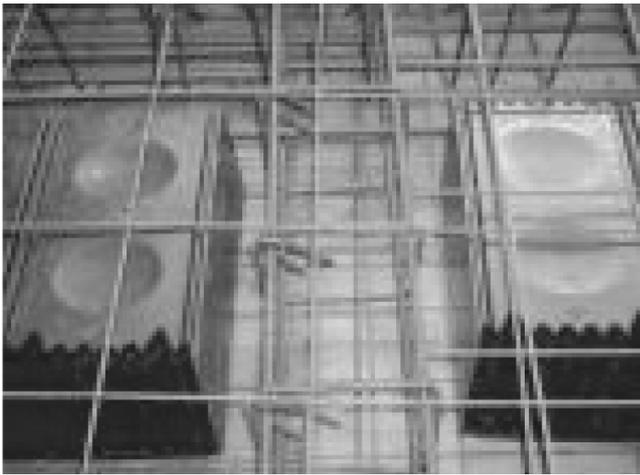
Устройство монолитного перекрытия при помощи системы U-Bahn Beton
